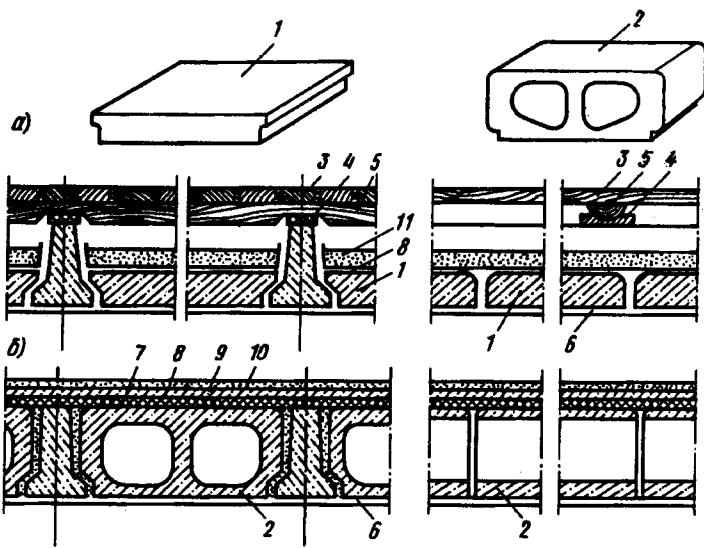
Перекрытия по сборным железобетонным балкам с накатом из сплошных плит (а) и с заполнением двухпустотными вкладышами (б)
